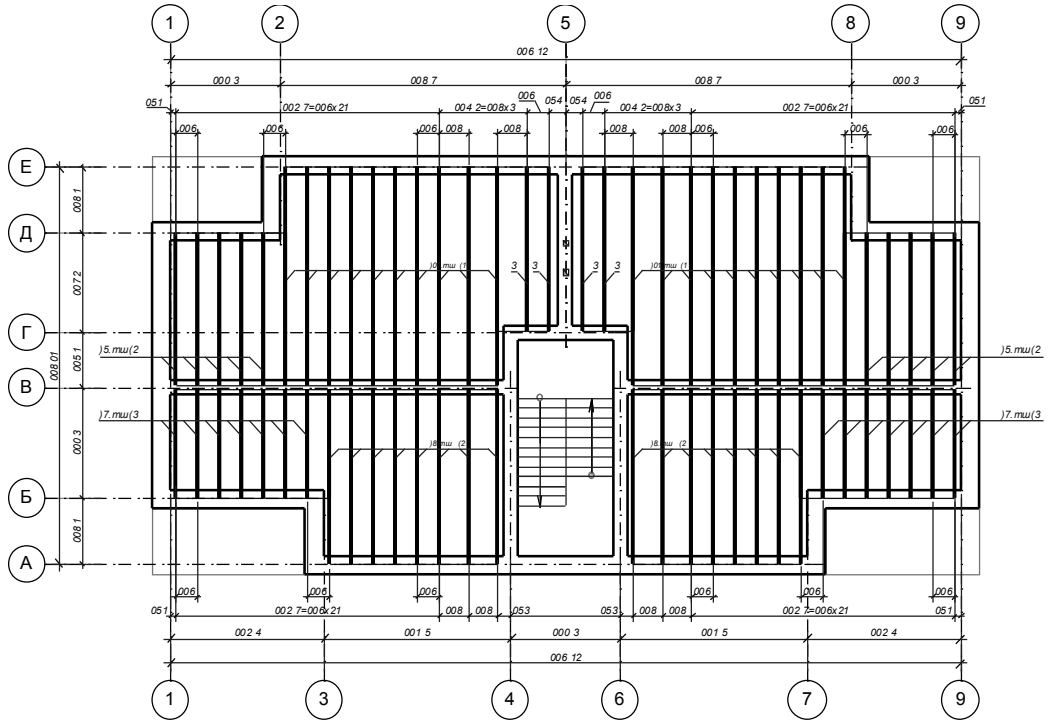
Пример оформления схемы расположения элементов балочного перекрытия
